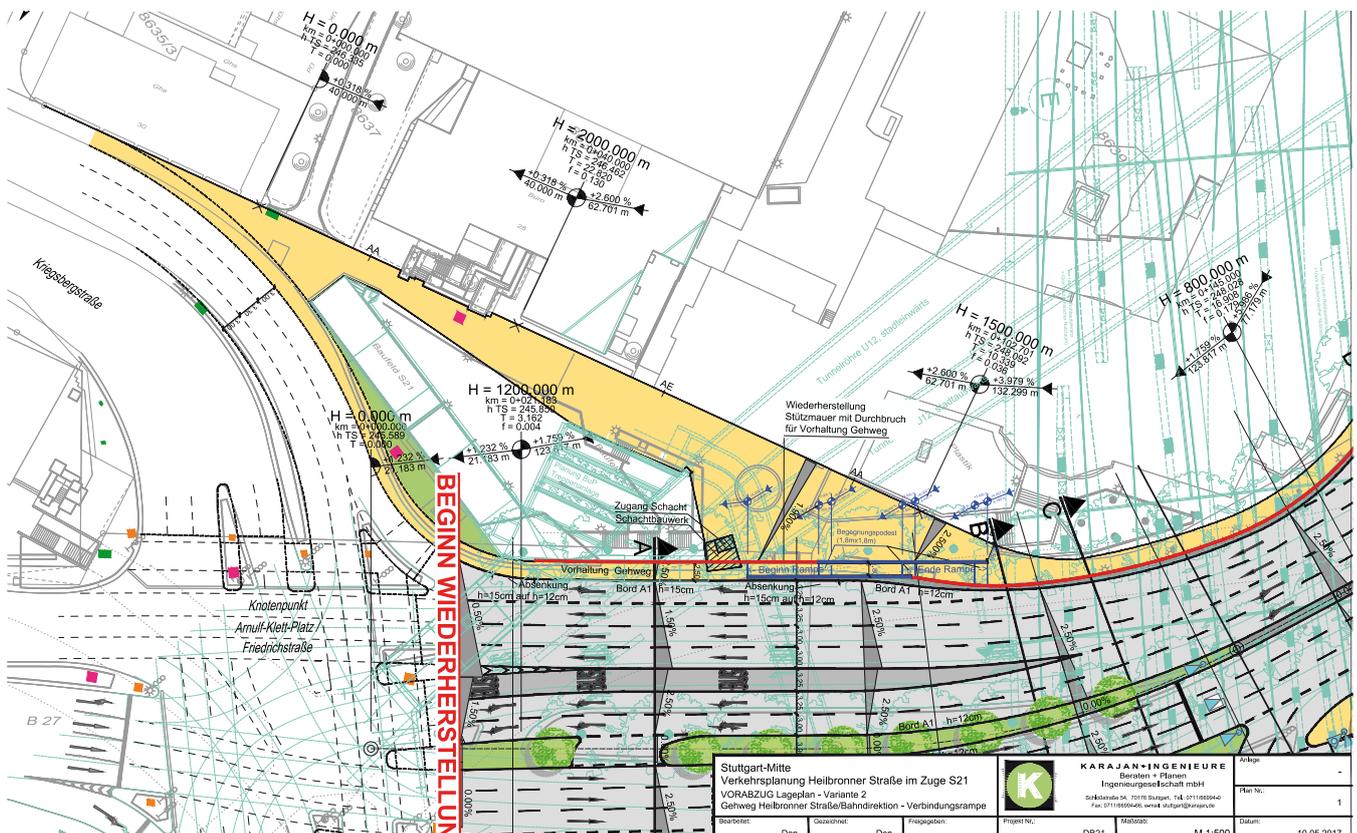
Bestehende Planung zum südlichen Vorplatz, Karajan Ingenieure, Stuttgart
